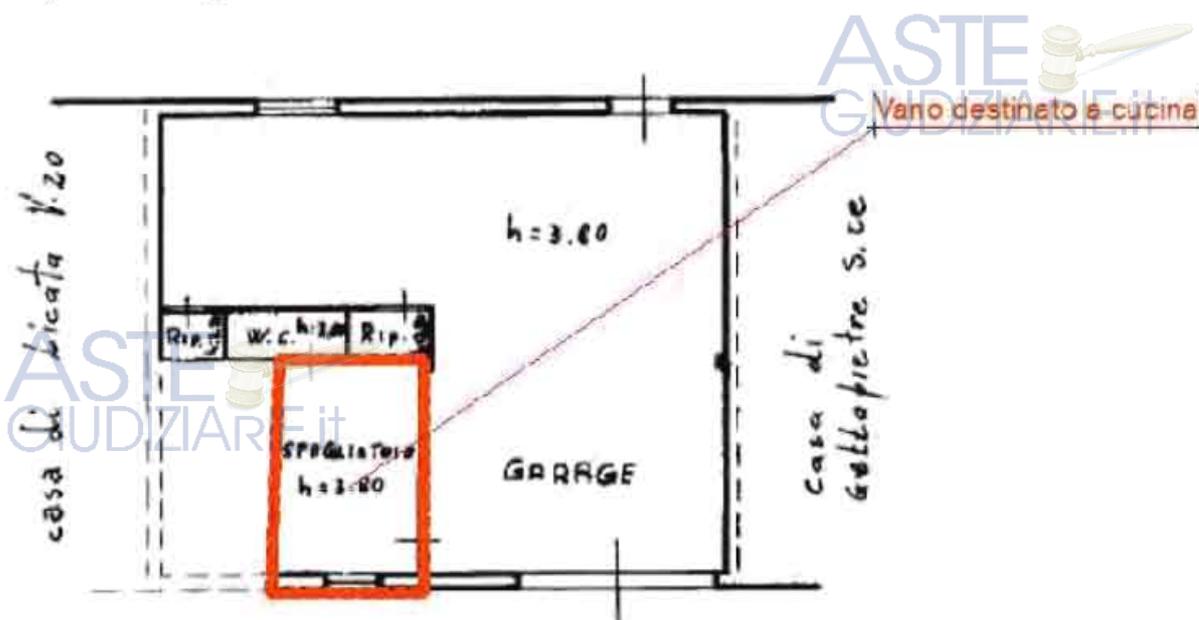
Planimetrie catastale con indicazione della porzione oggetto di cambio di destinazione d'uso
